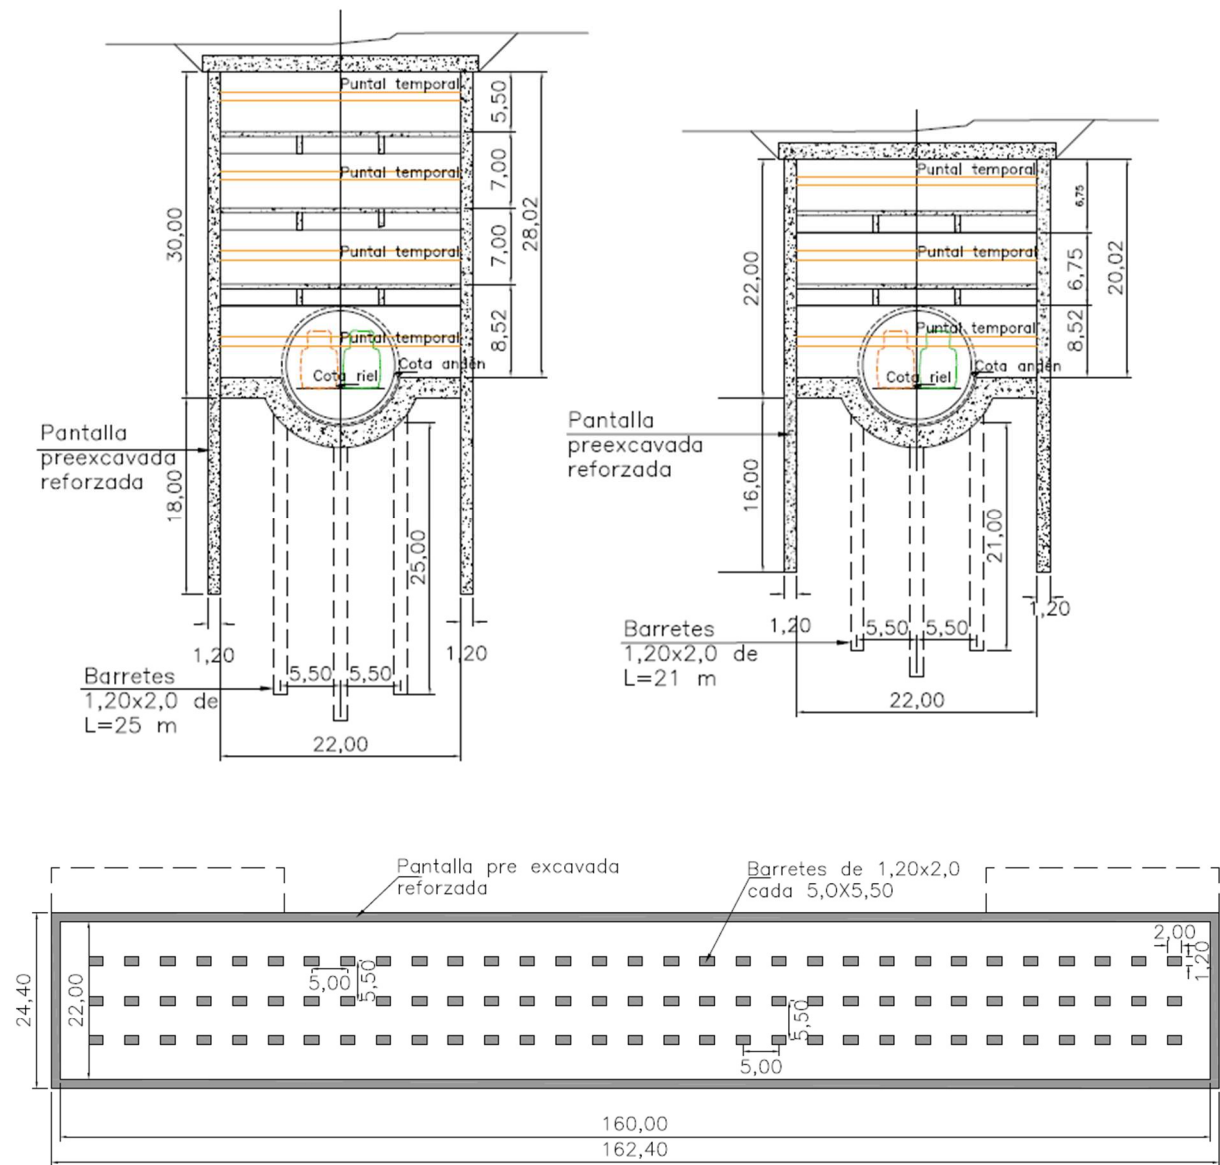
Secciones transversales de estaciones tipo y distribución en planta de barretes en el fondo de la estación.
